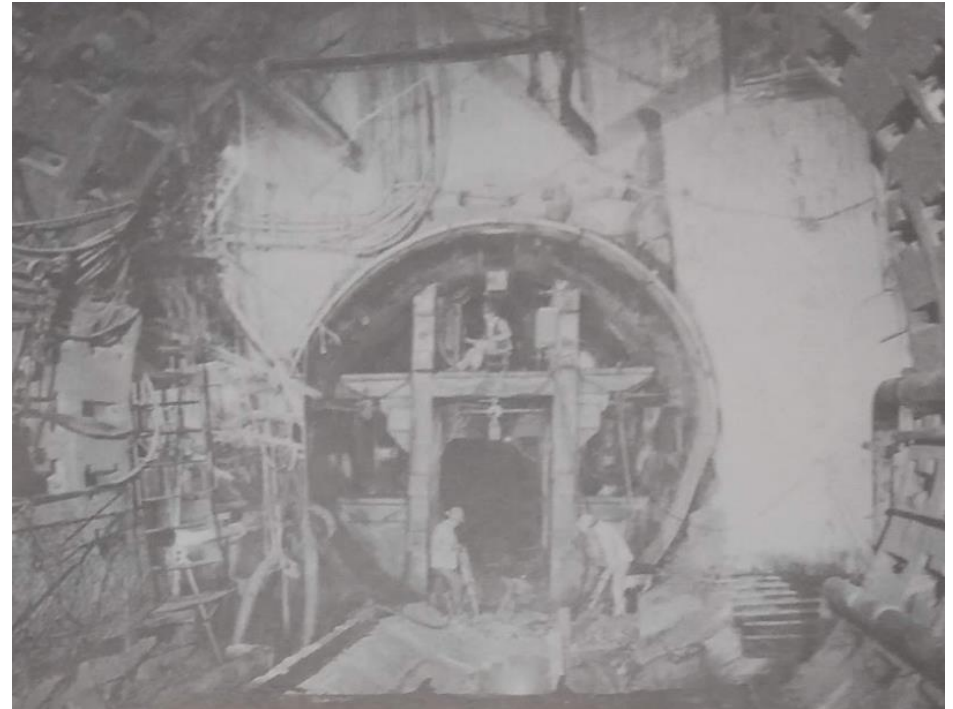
Trabajos de excavación para el drenaje a 220 metros de profundidad.
